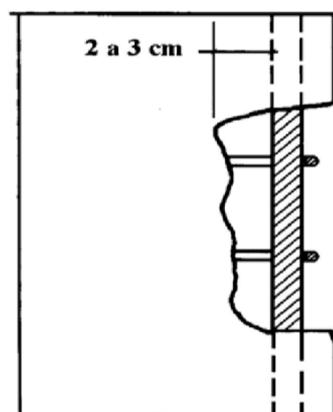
Corte de concreto mostrando a profundidade de remoção (Souza e Ripper, 1998)
